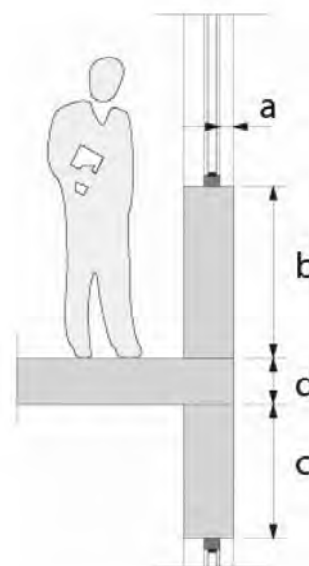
Schéma de principe d'un élément de façade étanche au feu E 60 (longueur minimale  $a + b + c + d \geq 1m$ ). (source : CSTC).
